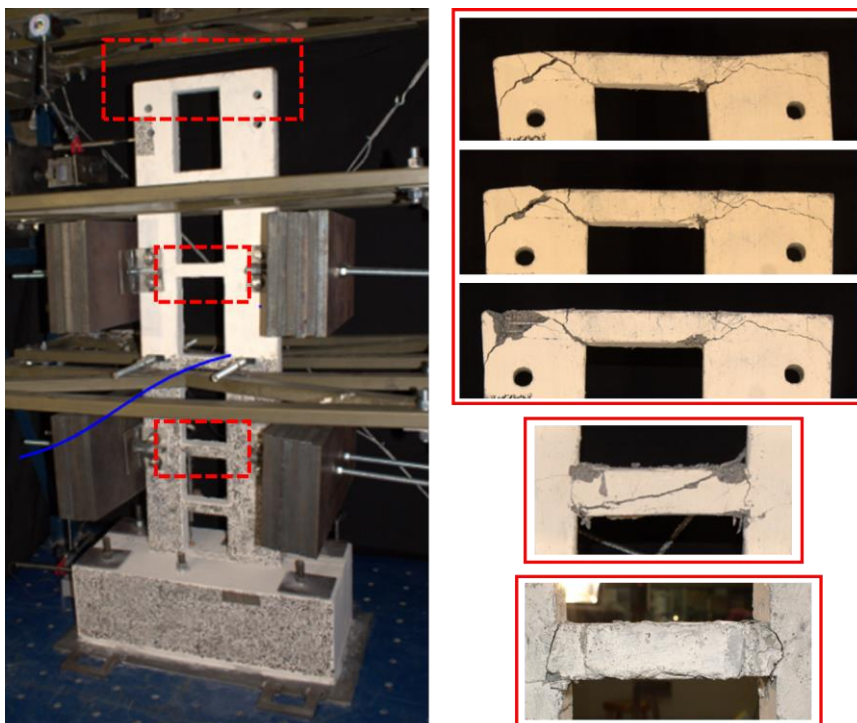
Detalle de fisuras en la parte superior del muro y falla de dos vigas – Probeta 1
